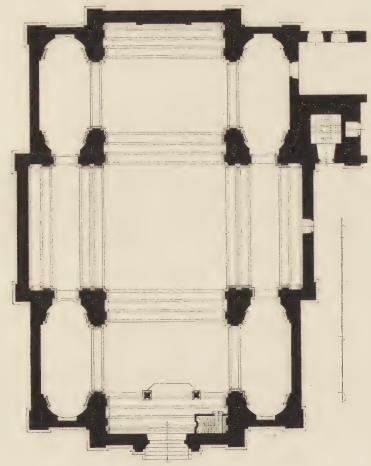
Konviktskirche zu Ehingen. Grundriss.
